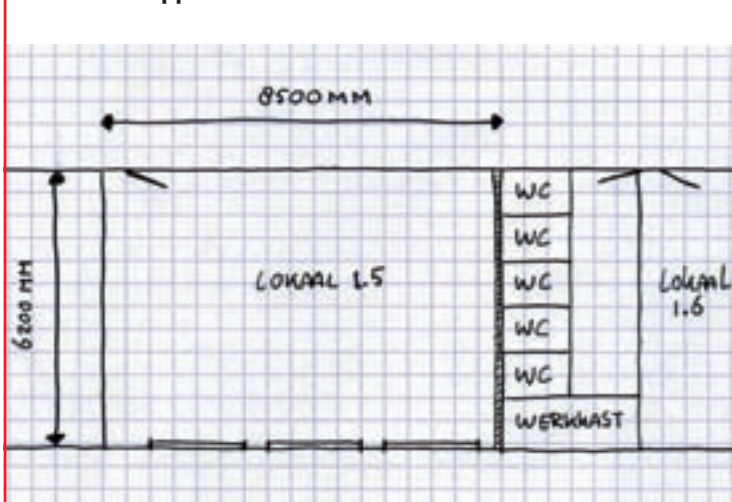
Handelingsniveau 2: voorstellen – concreet
